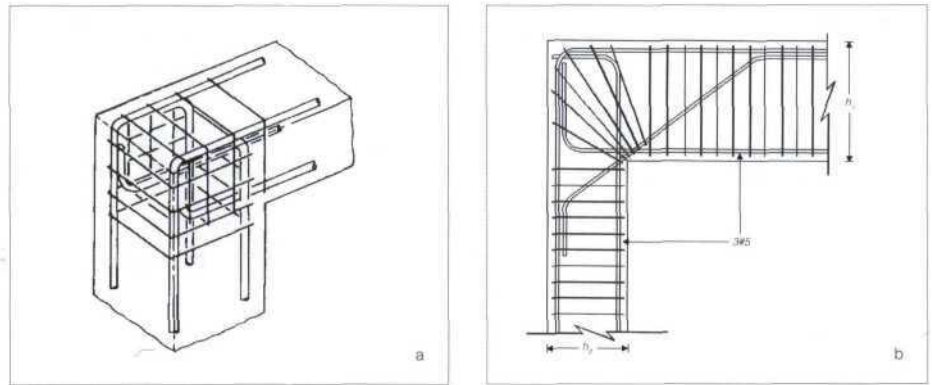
a. Refuerzo ortogonal en juntas de rodilla sujetas a cargas alternas, estribos ortogonales, b. Refuerzo de la conexión utilizada, [5].
